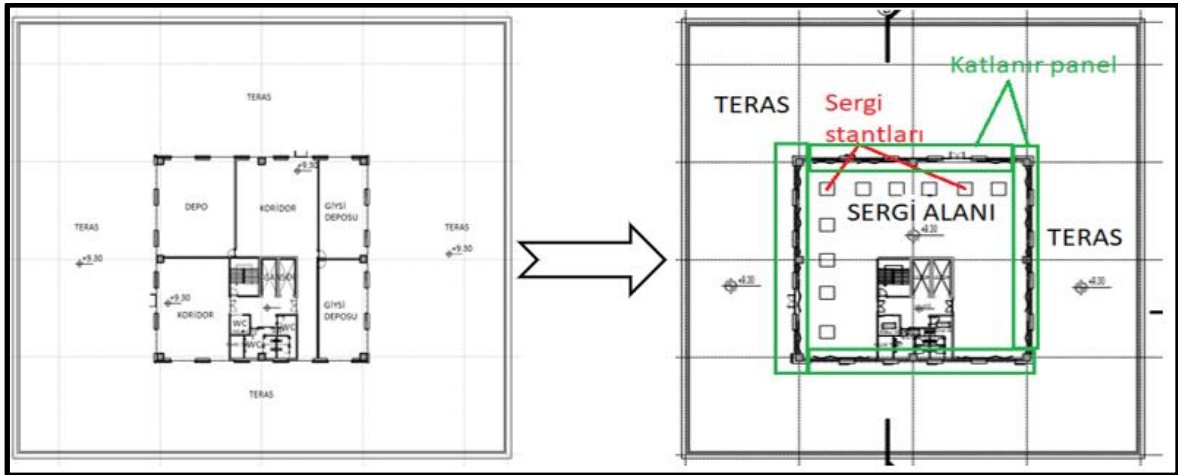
2.kat eski plan ve yeni plan düzenlemesi
